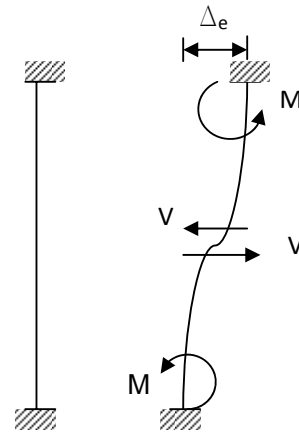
Comportamiento inelástico de las columnas en el sentido transversal.
